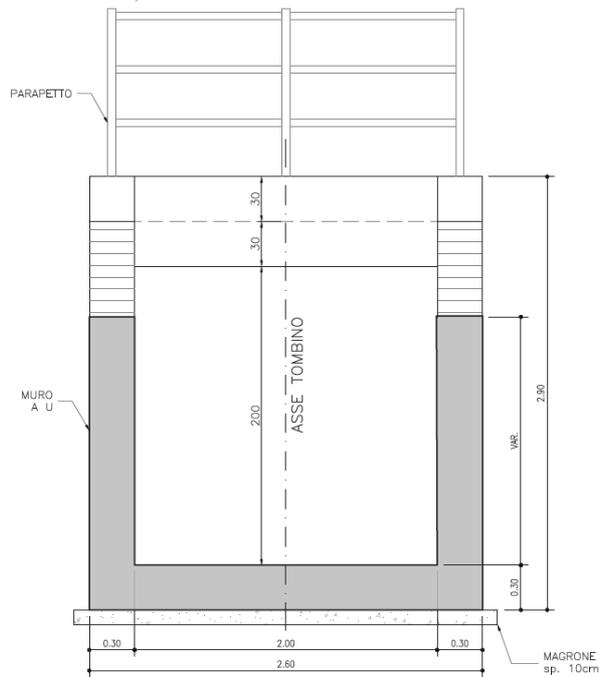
Muri d'imbocco - Sezione longitudinale
